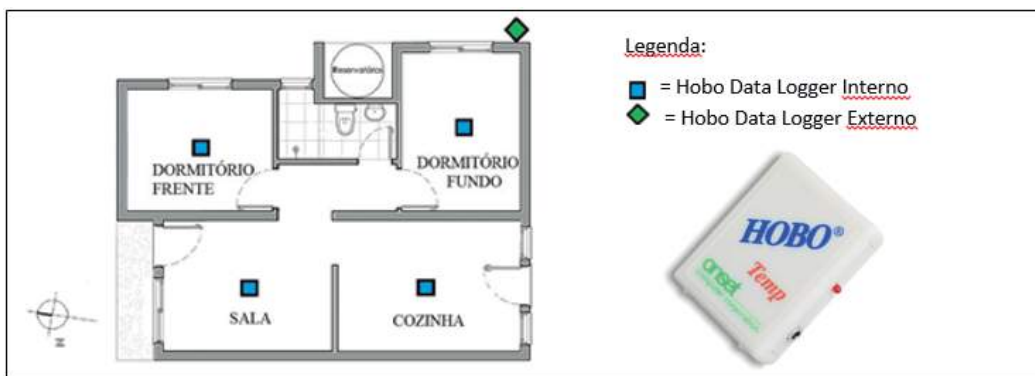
Planta Baixa com a localização dos medidores (Fonte: Vaghetti et al.,2013).
